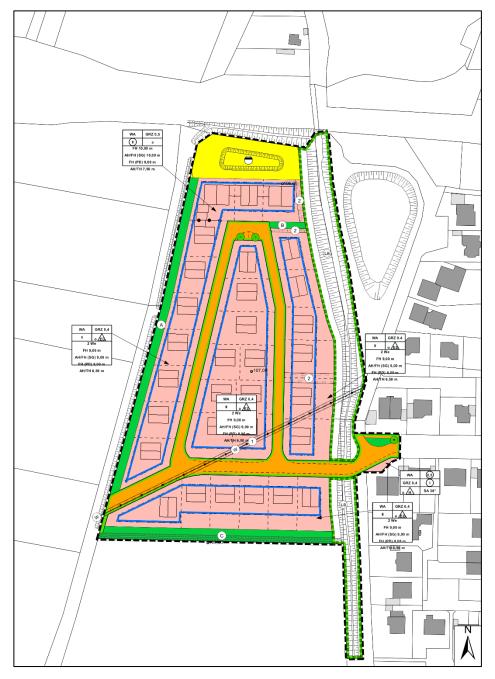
Städtebaulicher Vorentwurf (Ausschnitt, Quelle: Wallfahrtsstadt Werl, Stand: April 2020)
